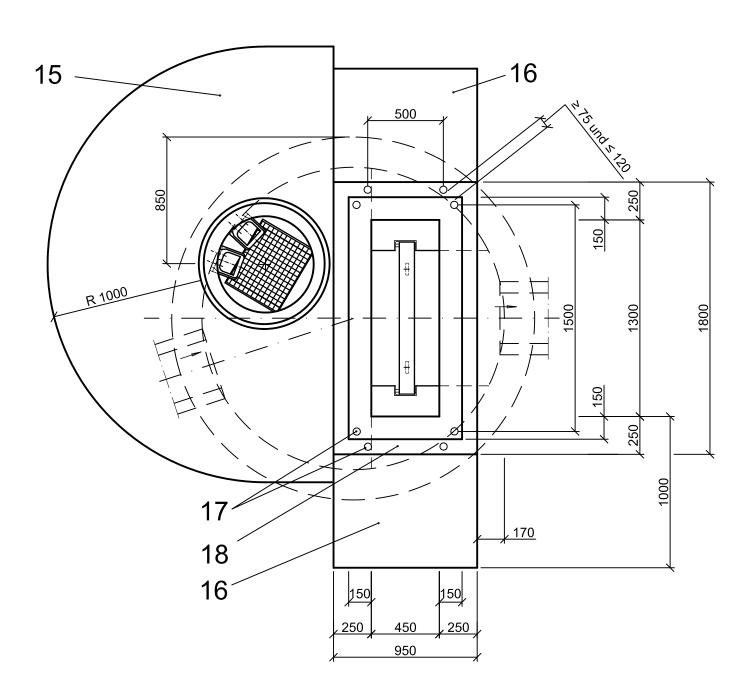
Schachtsandfang DN 2000 mit Tauchwand – Draufsicht (Prinzipskizze)
